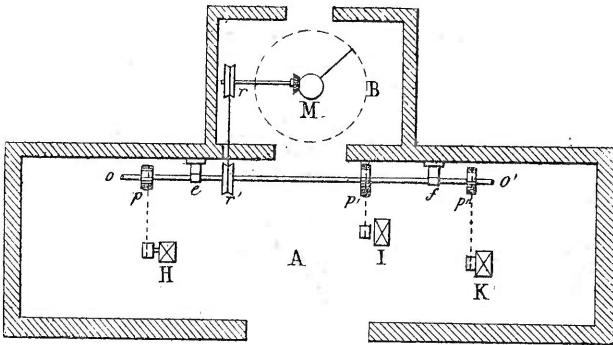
Plan d'une grange avec manège établi dans un bâtiment placé sur l'une des façades.
